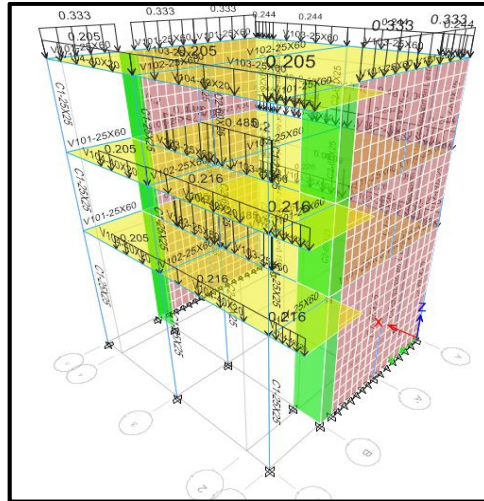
Bloque 1 cargas muertas lineales por tabiquería y parapetos
